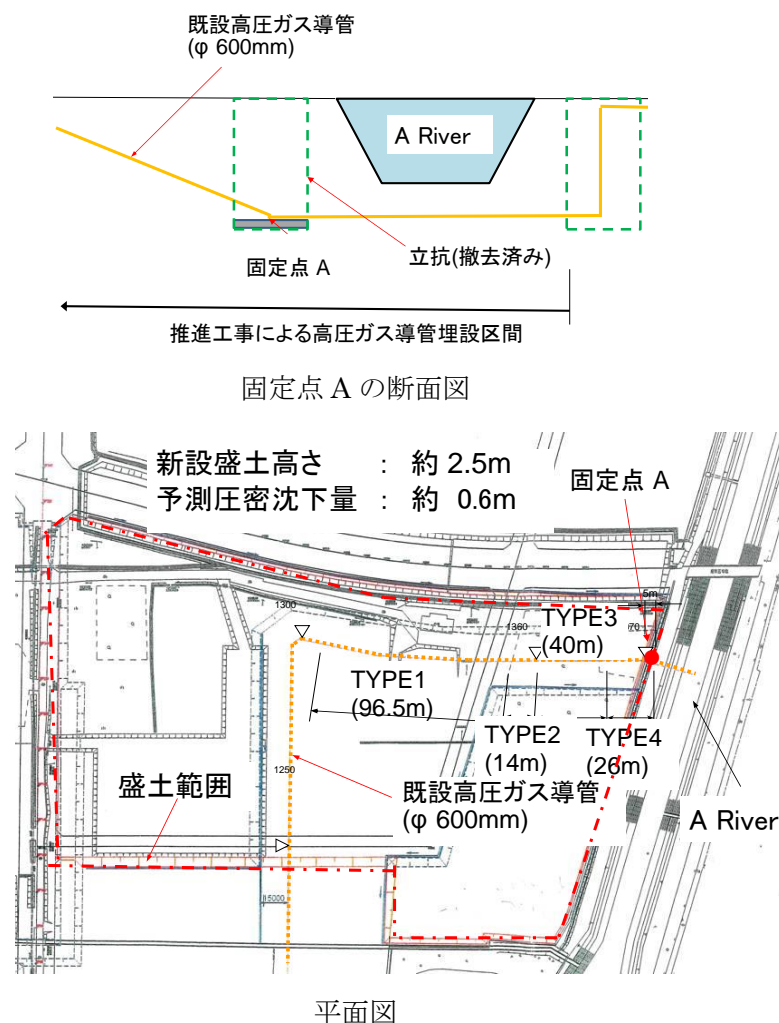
既設高压ガス導管の埋設位置の平面図と固定点 A の断面図
